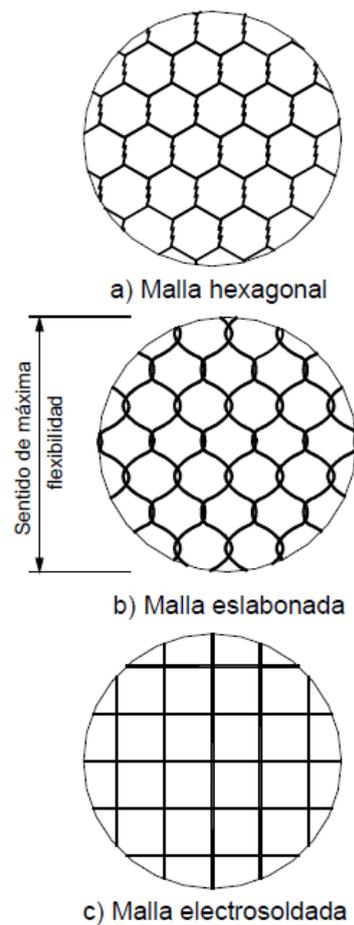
Tipos de mallas utilizadas en la construcción de gaviones. Fuente: (Suárez Díaz, 2001).
